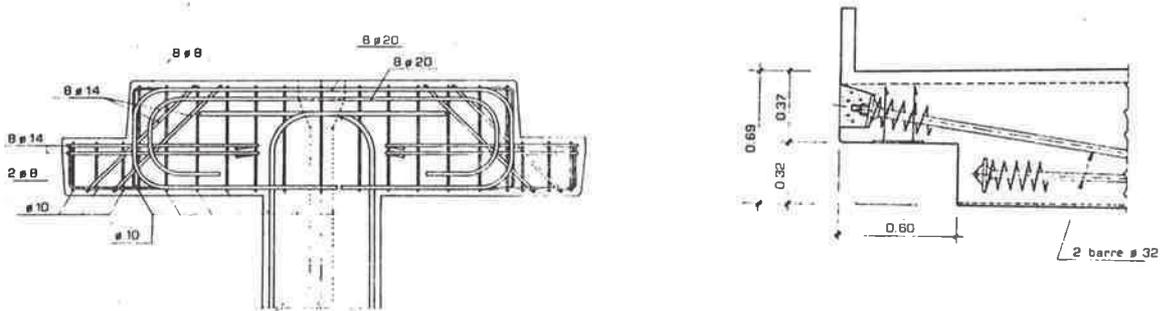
b - Denti sul pilastro e sulla nervatura della piastra
